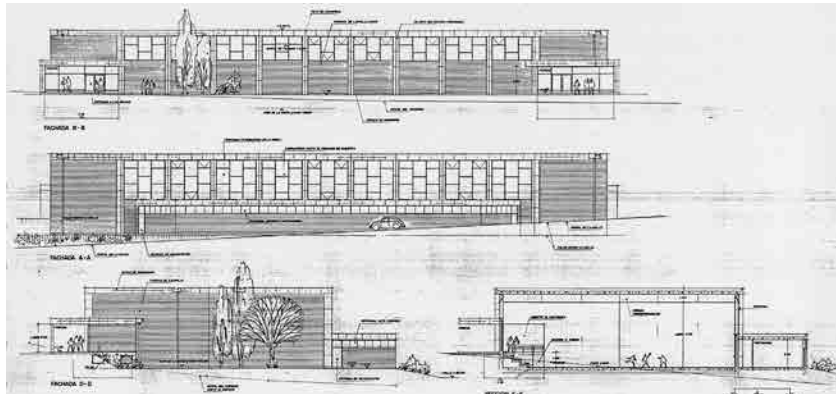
, Fig. 59, Fig. 60 y Fig. 61 Pabellón polideportivo. Alzado principal (arriba), alzado posterior (centro), alzado lateral (abajo izquierda) y sección transversal (abajo derecha).
